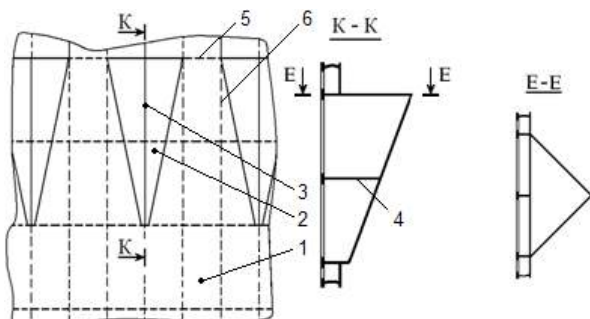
Принципиальная конструкция ледового пояса с ледоразрушающими пирамидальными наделками, вытянутыми в вертикальном направлении:
